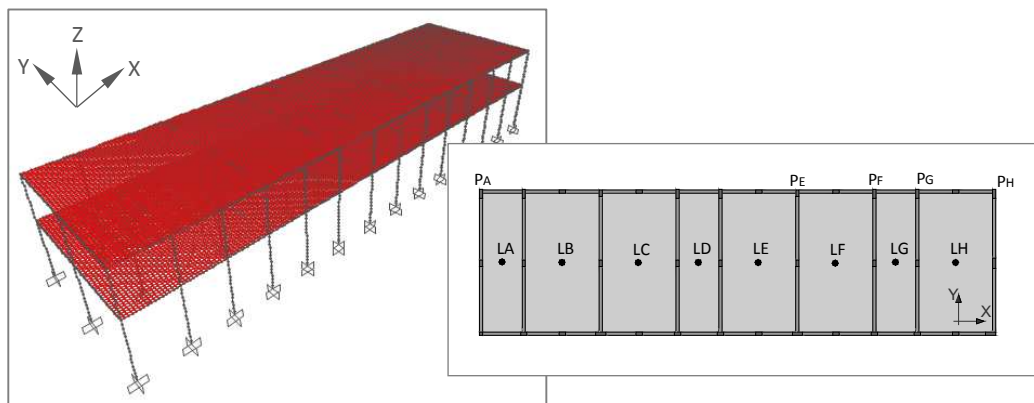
Planta da estrutura global tipo “D” e respetivo modelo de elementos finitos
